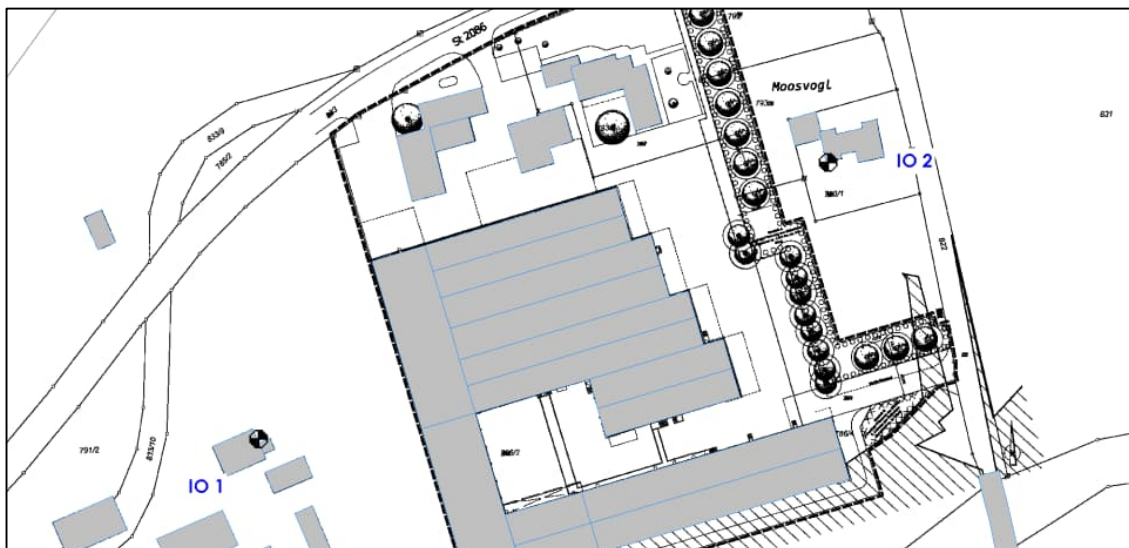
Lageplan mit Darstellung der maßgeblichen Immissionsorte
